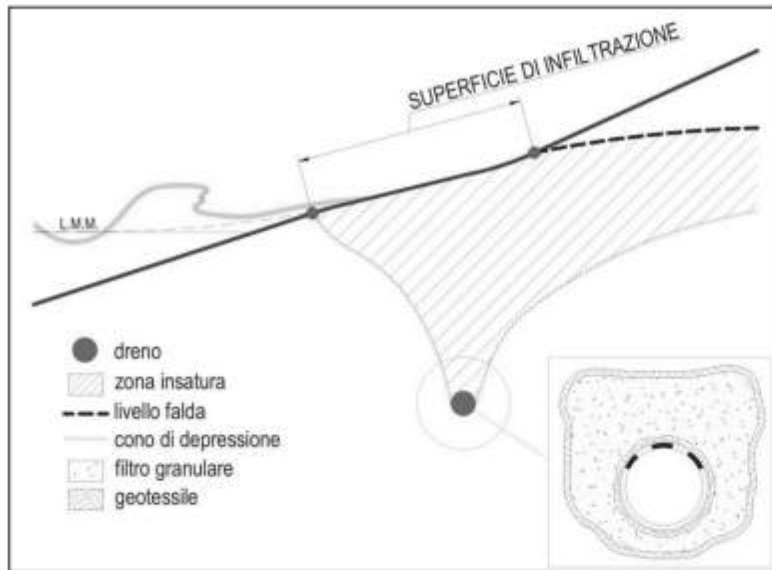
Azione del BMS sulla piezometria e particolare della sezione del dreno.
